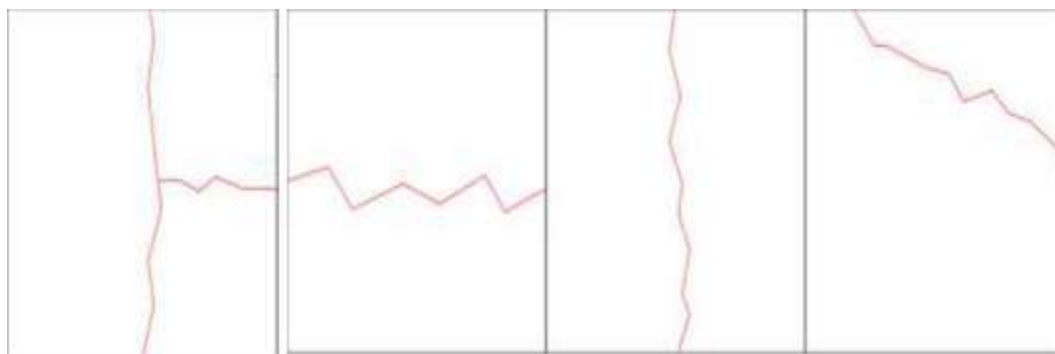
Grietas tipo (L1) (Diagnósticos et al., 2022).
